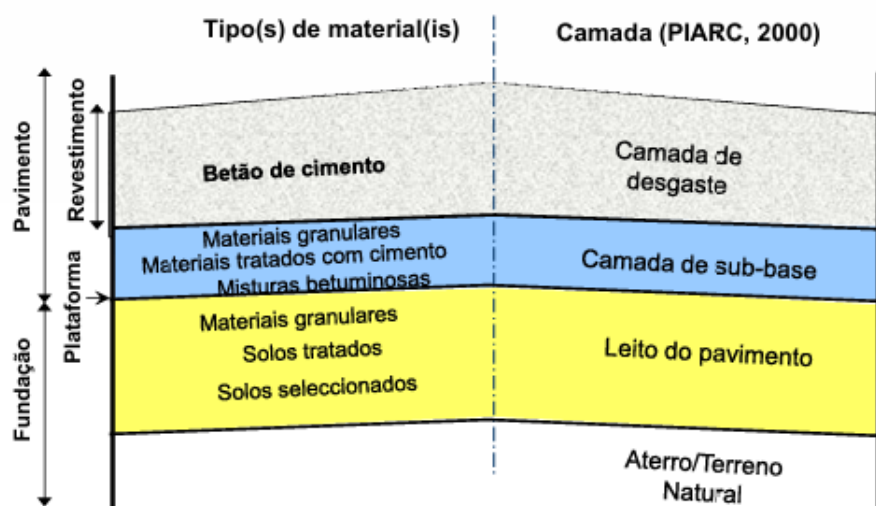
Estrutura de um pavimento rígido. Fonte: Fontul (2023).
